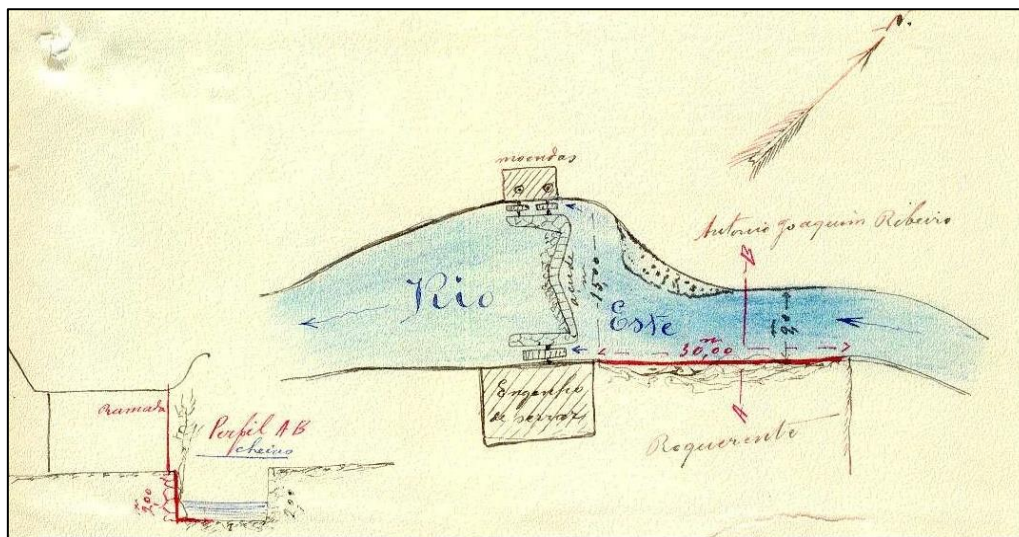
Planta e corte relativos ao processo para construir um muro de suporte, na margem esquerda do rio Este (Cestões, Cavalões, Vila Nova de Famalicão, 1908). Fonte: APA.
